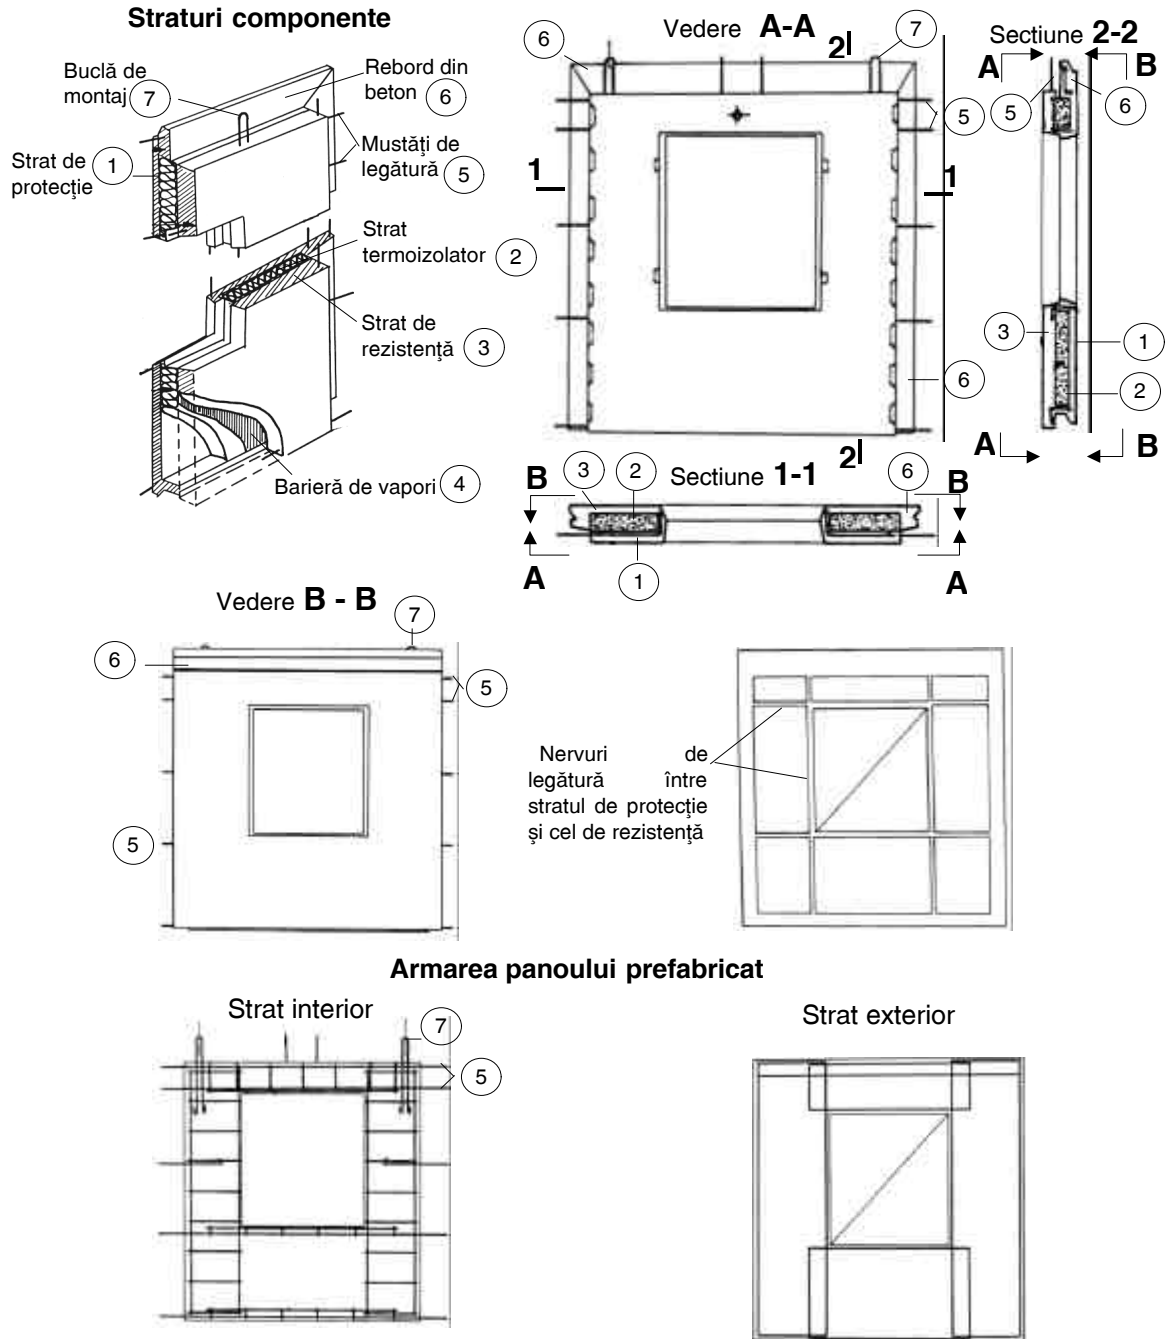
II.6 Panou prefabricat sandwich din beton armat. Alcătuire constructivă. Armare.
